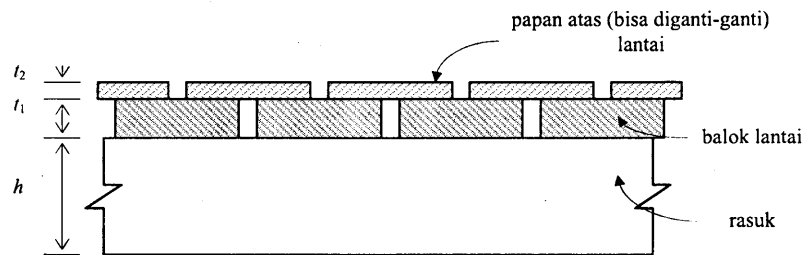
Asumsi dalam penghitungan balok lantai
